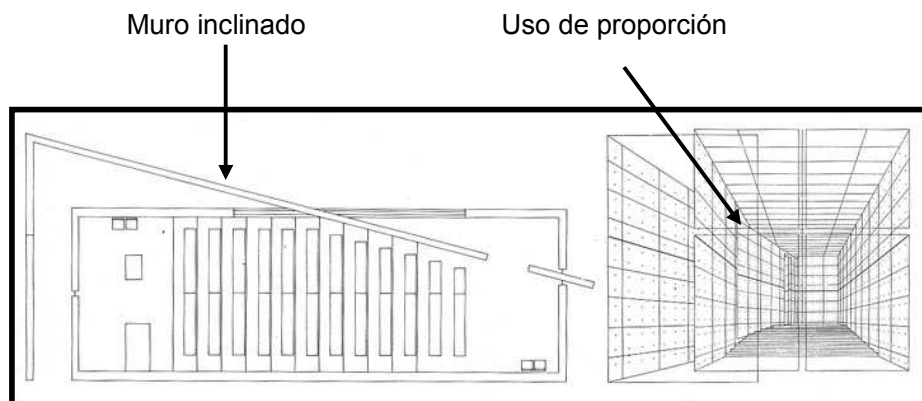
Planta arquitectónica y perspectiva de la Iglesia de la luz.
